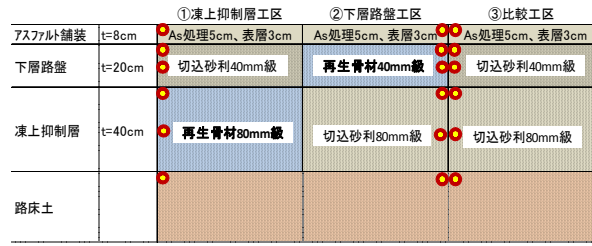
試験施工箇所 (日本製紙構内) 施工時期 H22. 10
